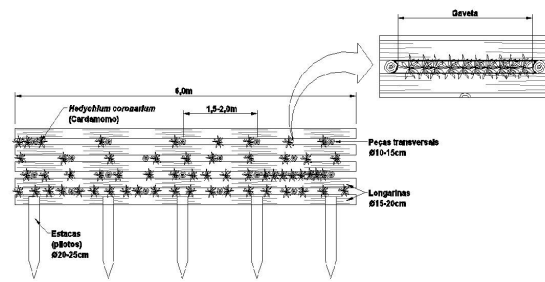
Peças componentes da parede Krainer — troncos longitudinais, transversais e estacas vivas antes da montagem.
